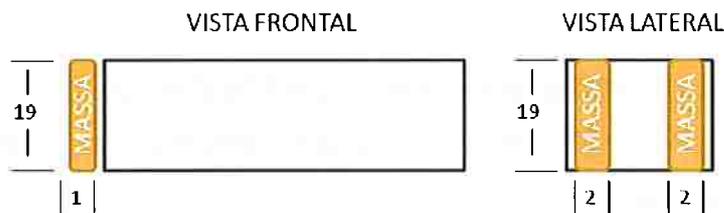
Colocação da junta vertical no bloco de alvenaria estrutural
